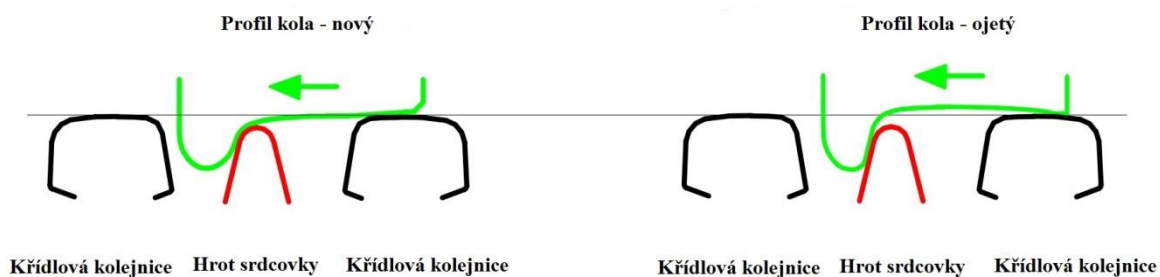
Schematické znázornění přejezdu dvojkolí přes srdcovku – pohled shora [12]
